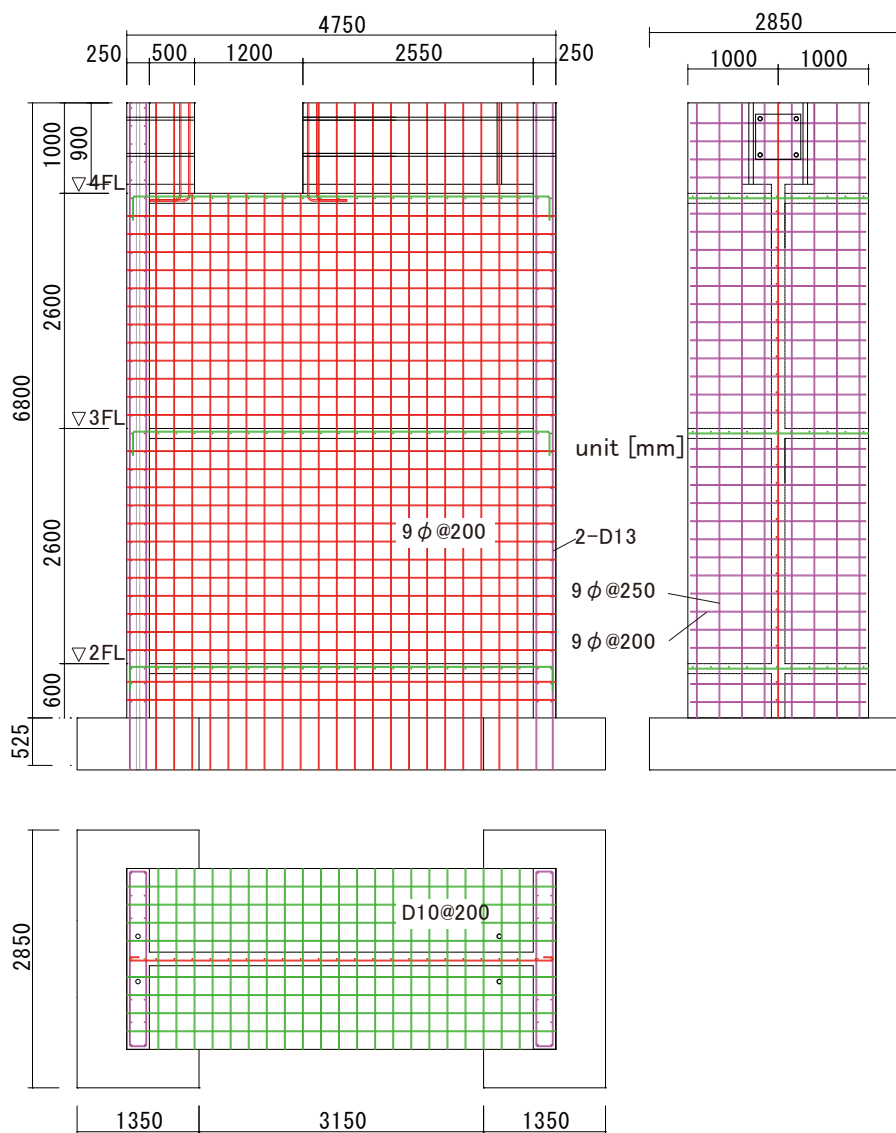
2.5 層連層耐力壁架構試験体 配筋図
